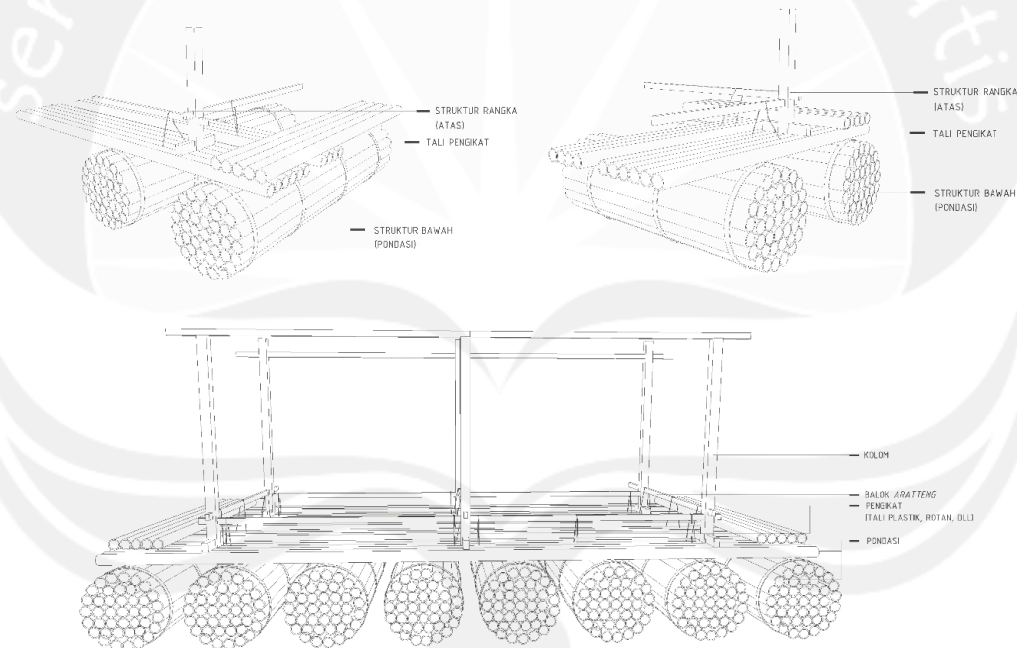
Struktur Pondasi Rumah Di Danau Tempe
